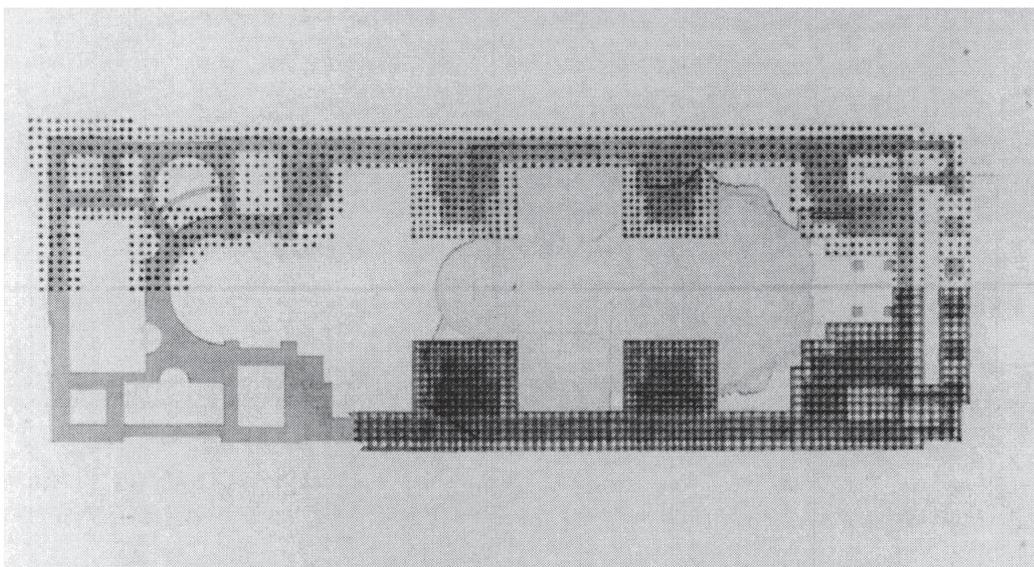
Pietro Nobile, pianta dei pali per le fondazioni. Collezione Fonda- Savio.
